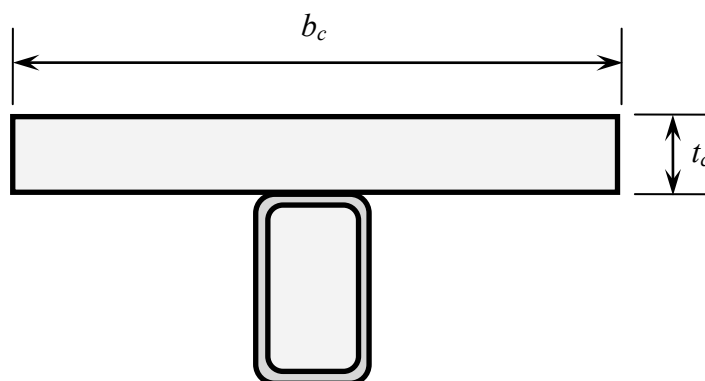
Dimensões da laje de concreto maciça colaborante
